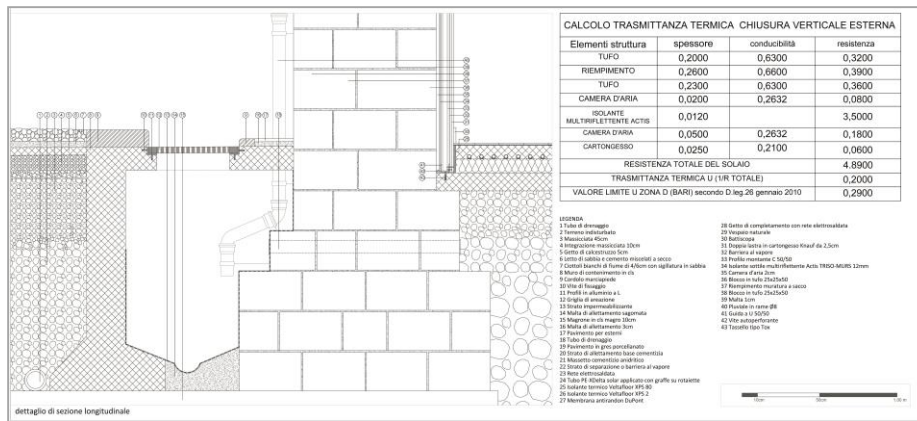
Chiusura verticale esterna (particolare e calcolo trasmittanza)
